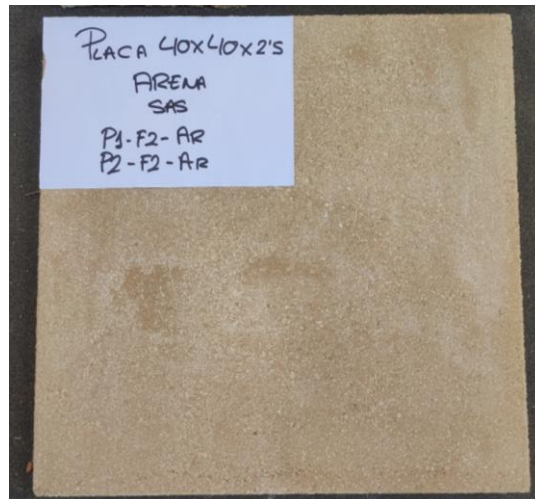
Fotografía pavimento Arenisca SAS1900. Fuente: Elaboración propia.
